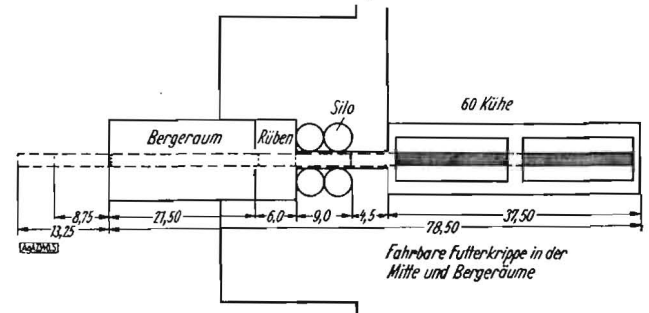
Grundriß eines Stalles für 60 Kühe mit fahrbarem Futtertisch
